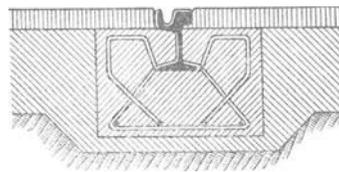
Langschwelle aus Eisenbeton mit Einbettung der Schiene.
